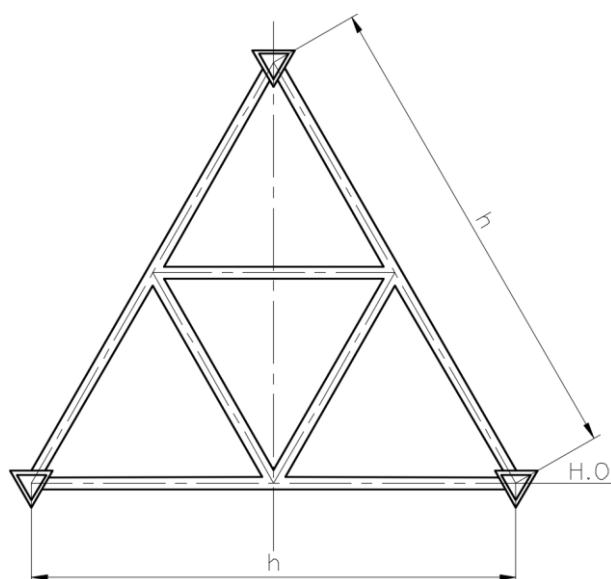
Схема поперечного сечения трехгранной ферменной опорной колоны с рейками треугольного сечения A3
